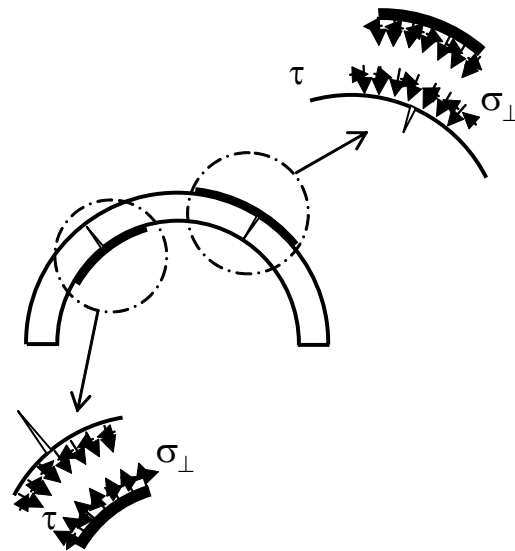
Scambio tensionale tra il rinforzo ed il contorno murario.
